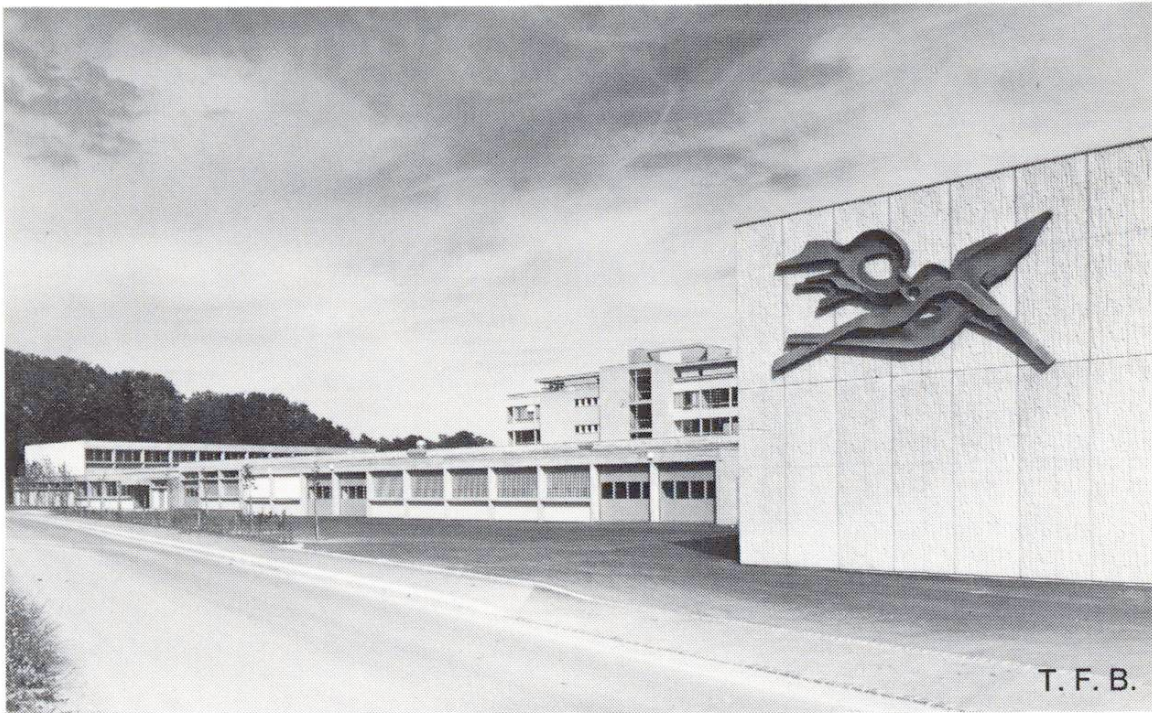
Gewerbeschule in Colombier, Fassadenplatten mit «Prewi»-Struktur.
